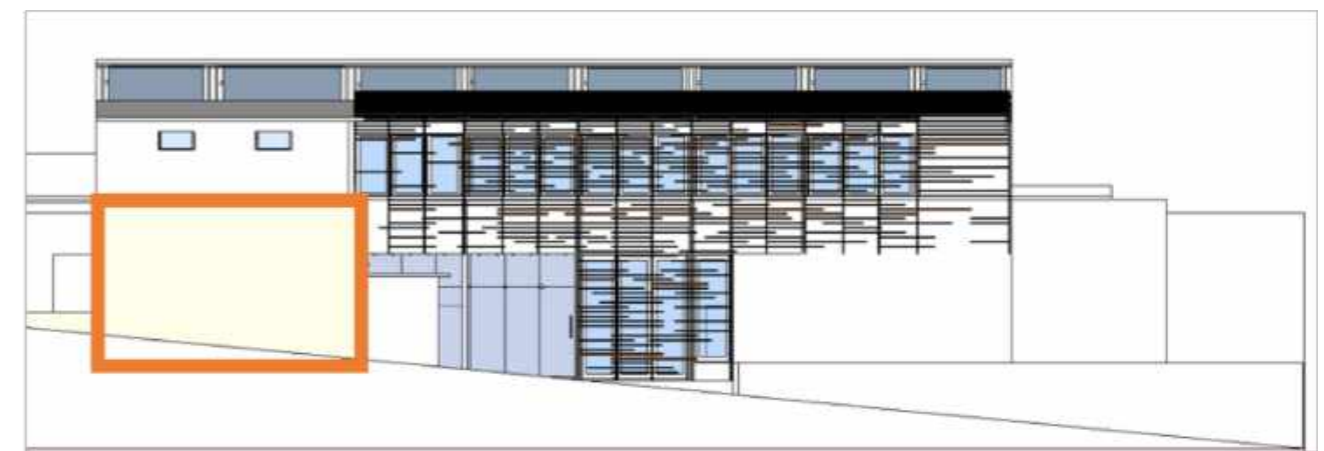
Sistema constructivo 2 en fachada sur. Fuente: Elaboración propia.
